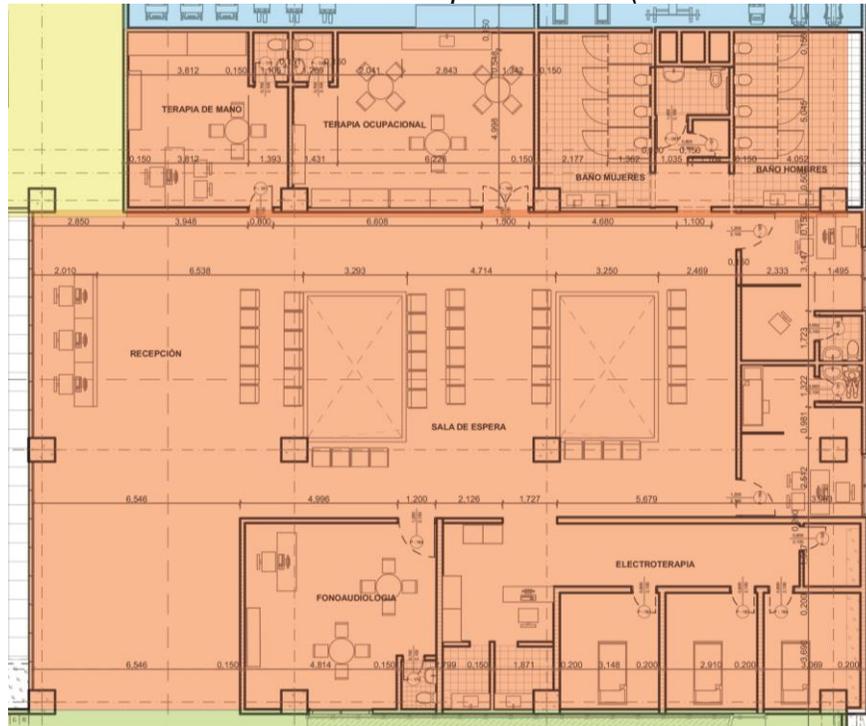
Rehabilitación física. (Plano Planta Piso 3)
